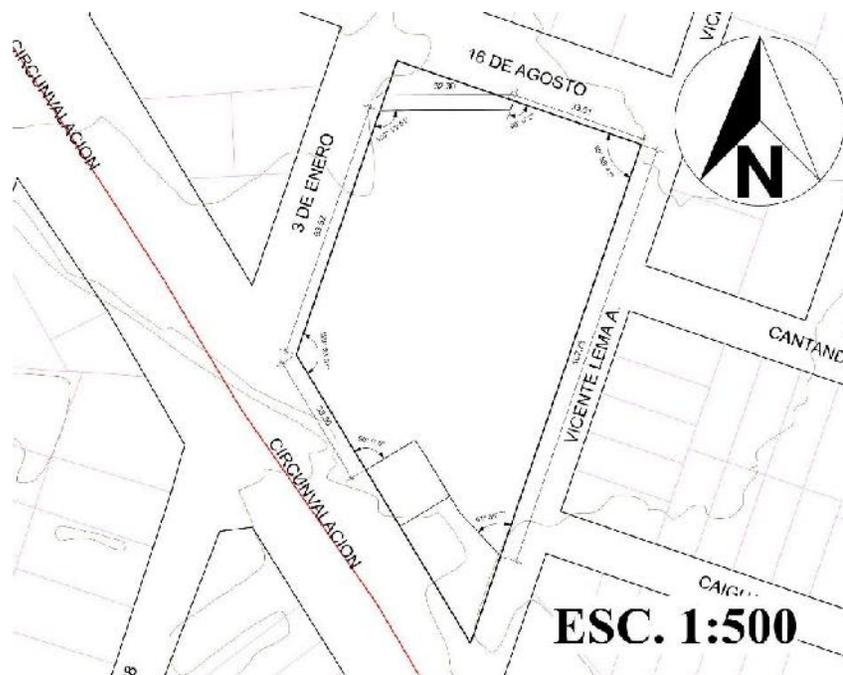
Plano de superficie. Fuente: Elaboración propia.
